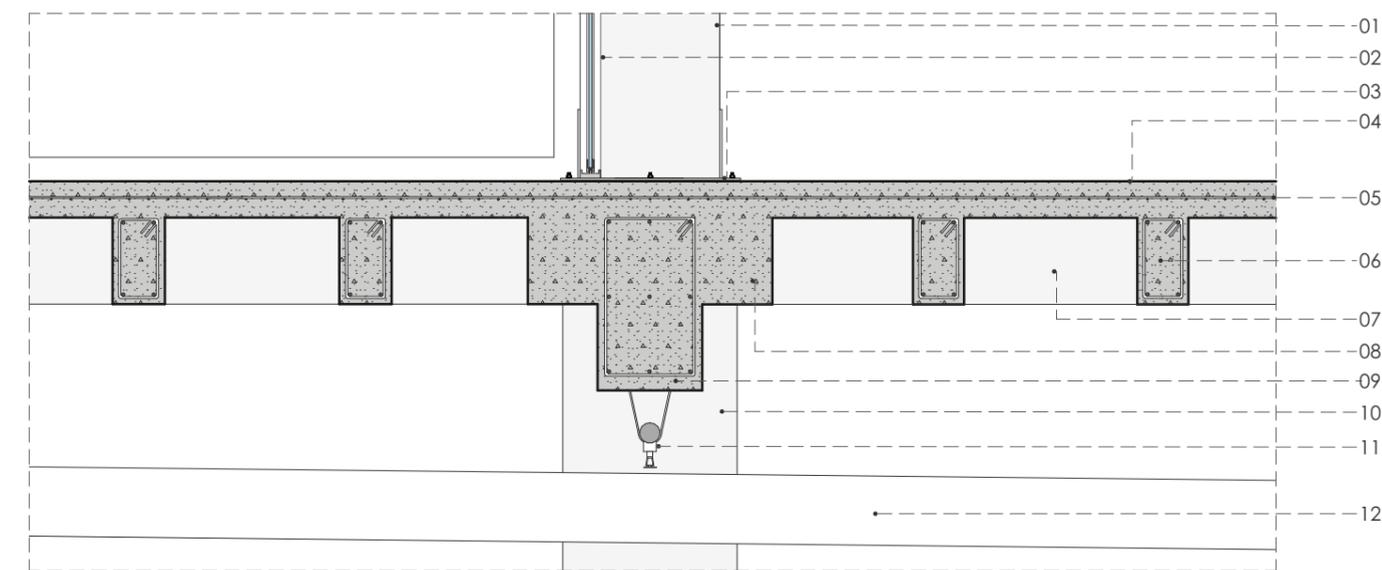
Detalle 02- entepiso Fuente: Propia, 2022
